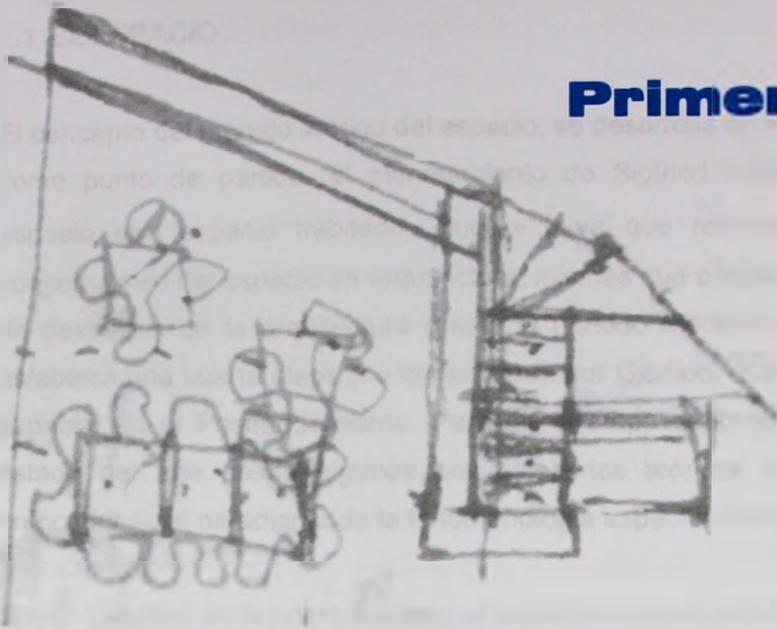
Croquis (Abril 2001) de la planta arquitectónica baja. Módulo de oficina. Obra Medina 2001.
